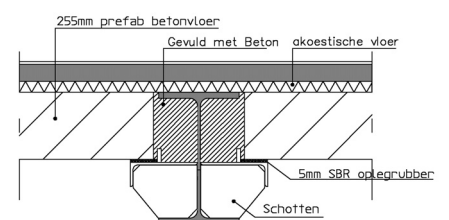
Aansluitingsdetail van vakwerk J op het middensteunpunt.
